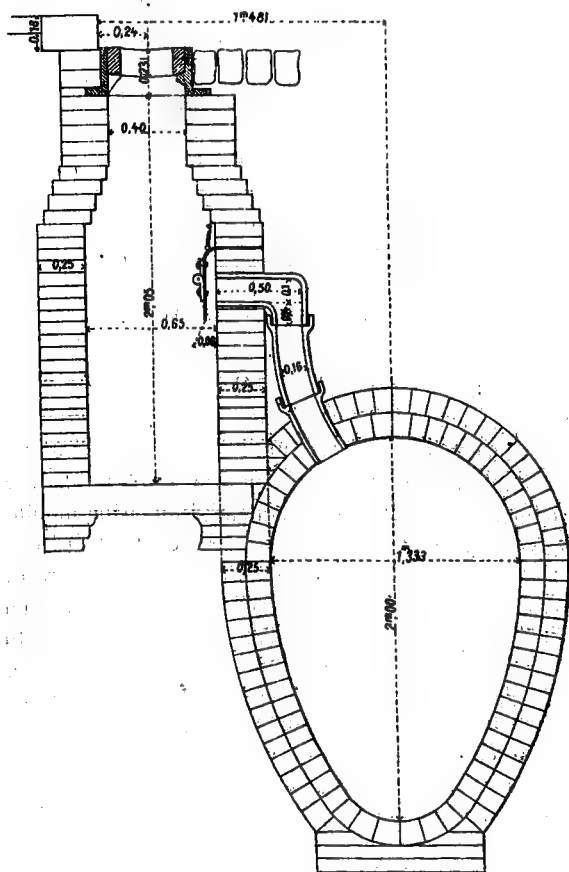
Coupe des égouts et des bouches d'égouts de Berlin.
